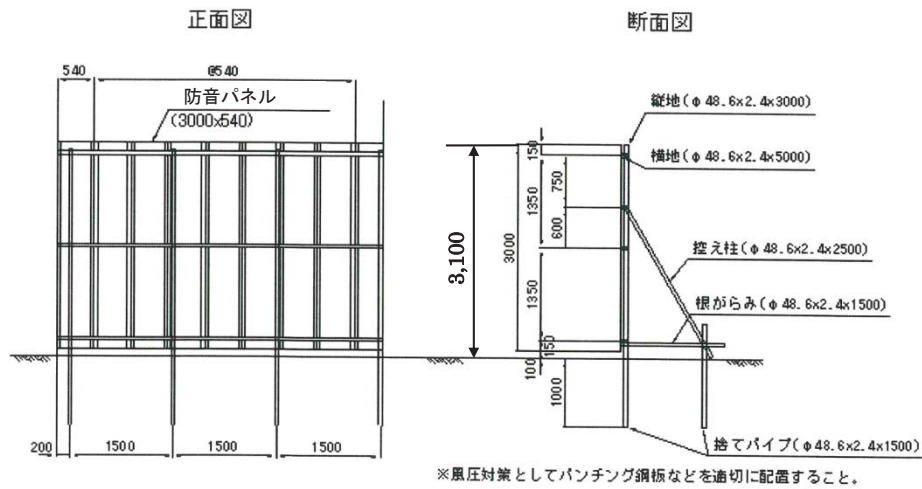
遮音壁の構造等 (参考図)
